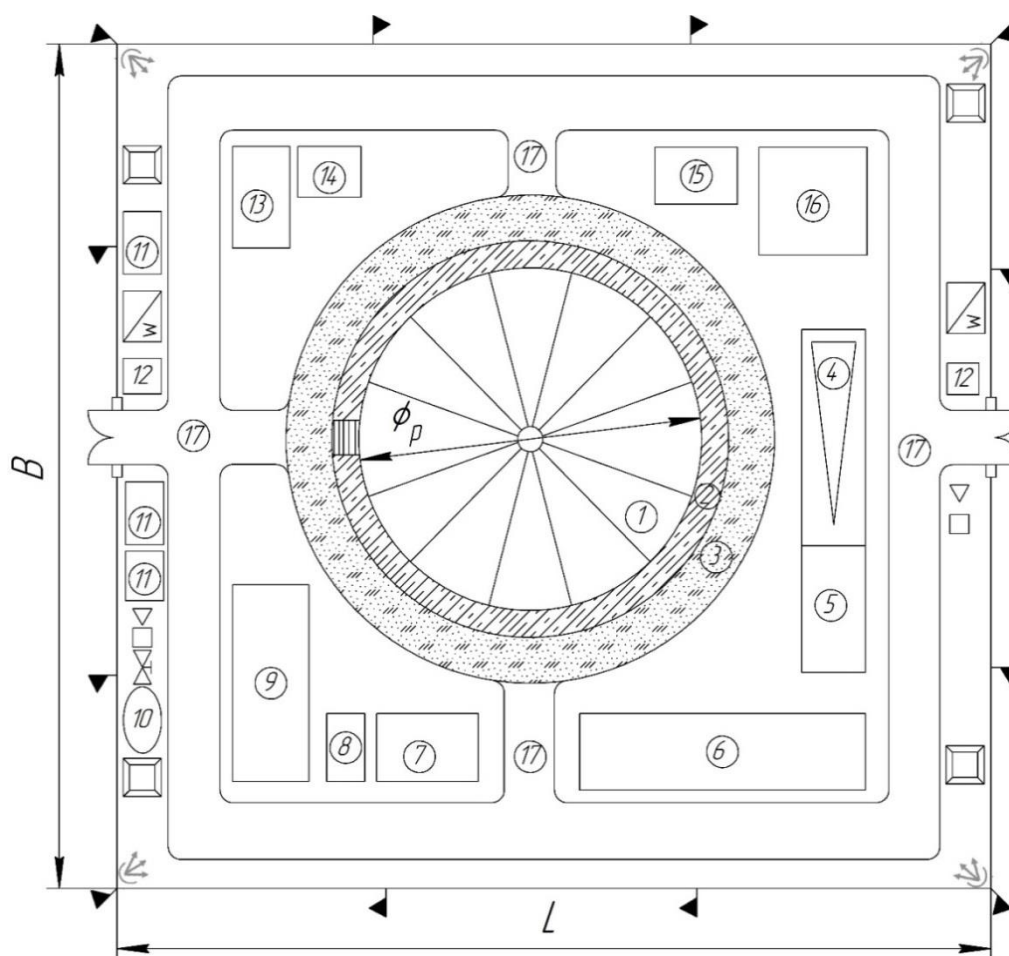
Планировка монтажной площадки сборки и сварки резервуара:
